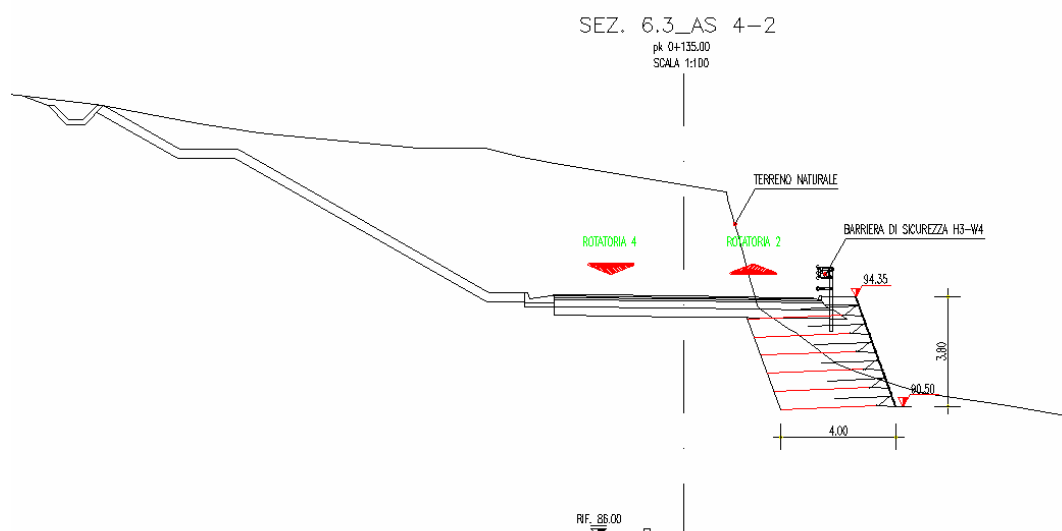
Sezione trasversale muro in TR ASSE 4-2
